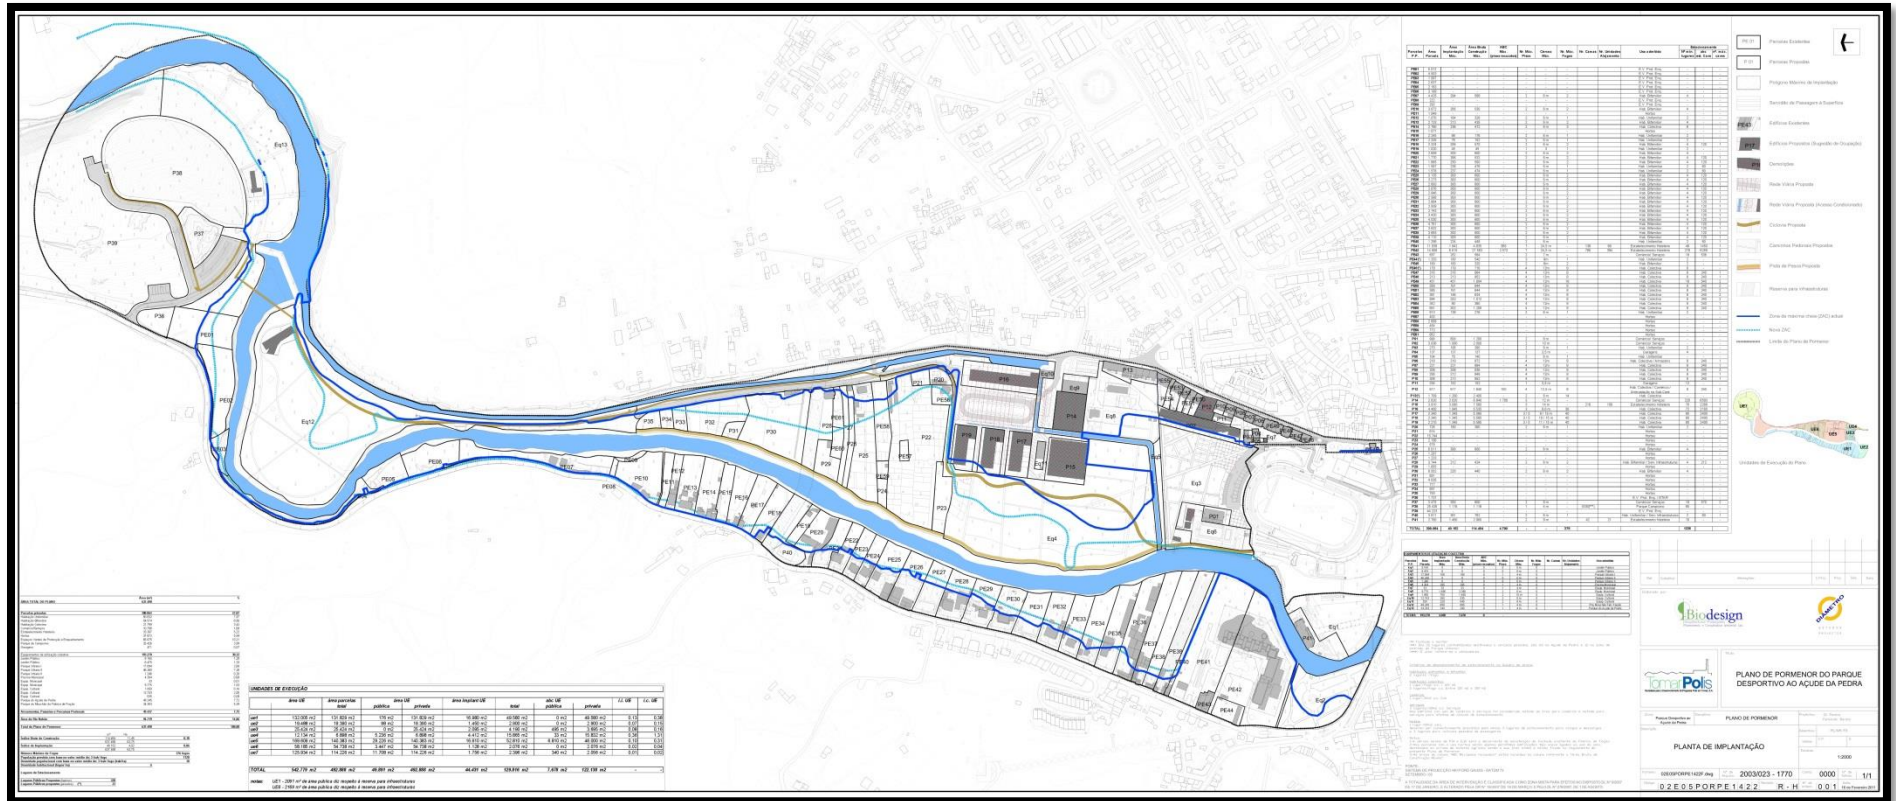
Planta de ordenamento do Plano de Pormenor do Parque Desportivo ao Açude de Pedra.
